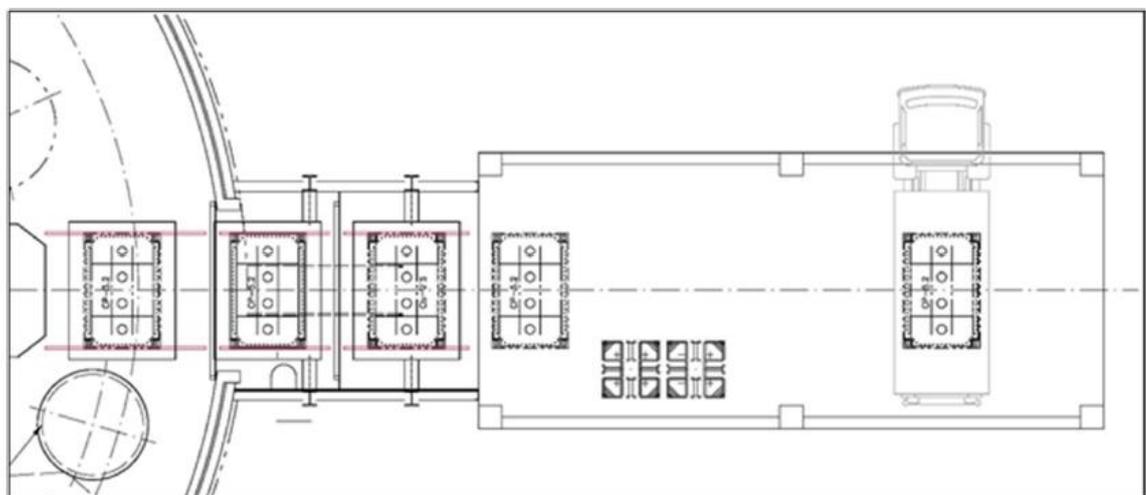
Layout sistemazione accesso lato Sud al Contenitore Stagno (pianta)
